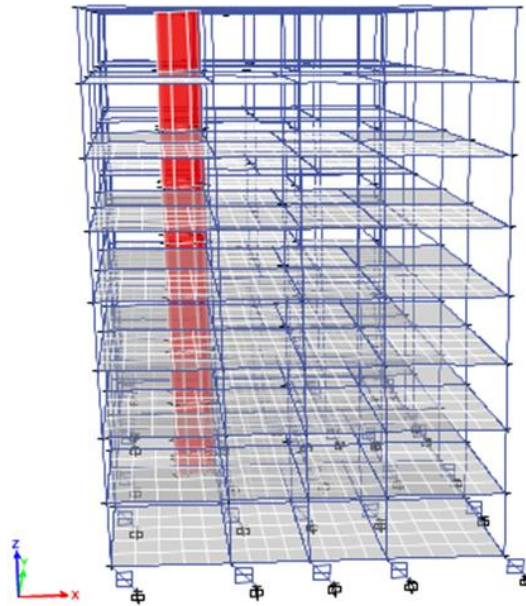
Vista de la estructura aislada en X - Bloque 1
